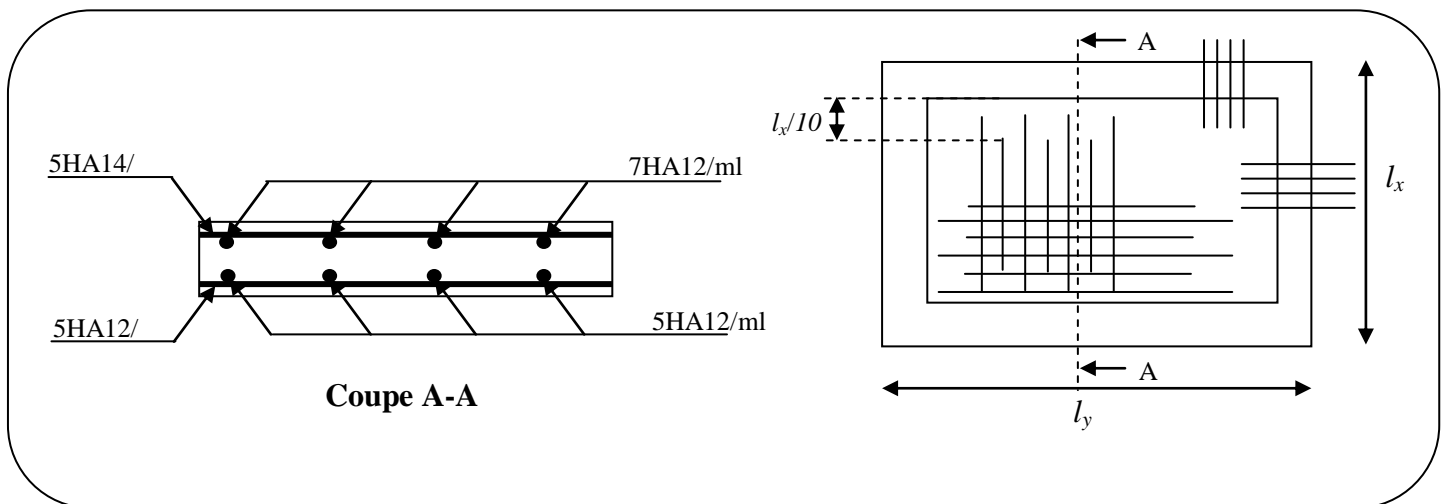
Schéma de ferrailage de la dalle du radier
